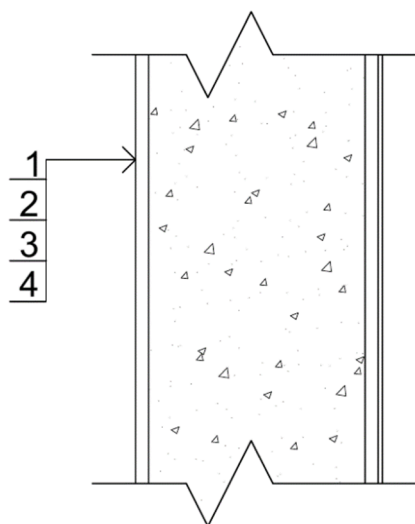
Расчетная схема ограждающих конструкций из газобетона: 1 – внутренняя отделка; 2 – газобетон; 3 – наружная отделка; 4 – фасадная краска
